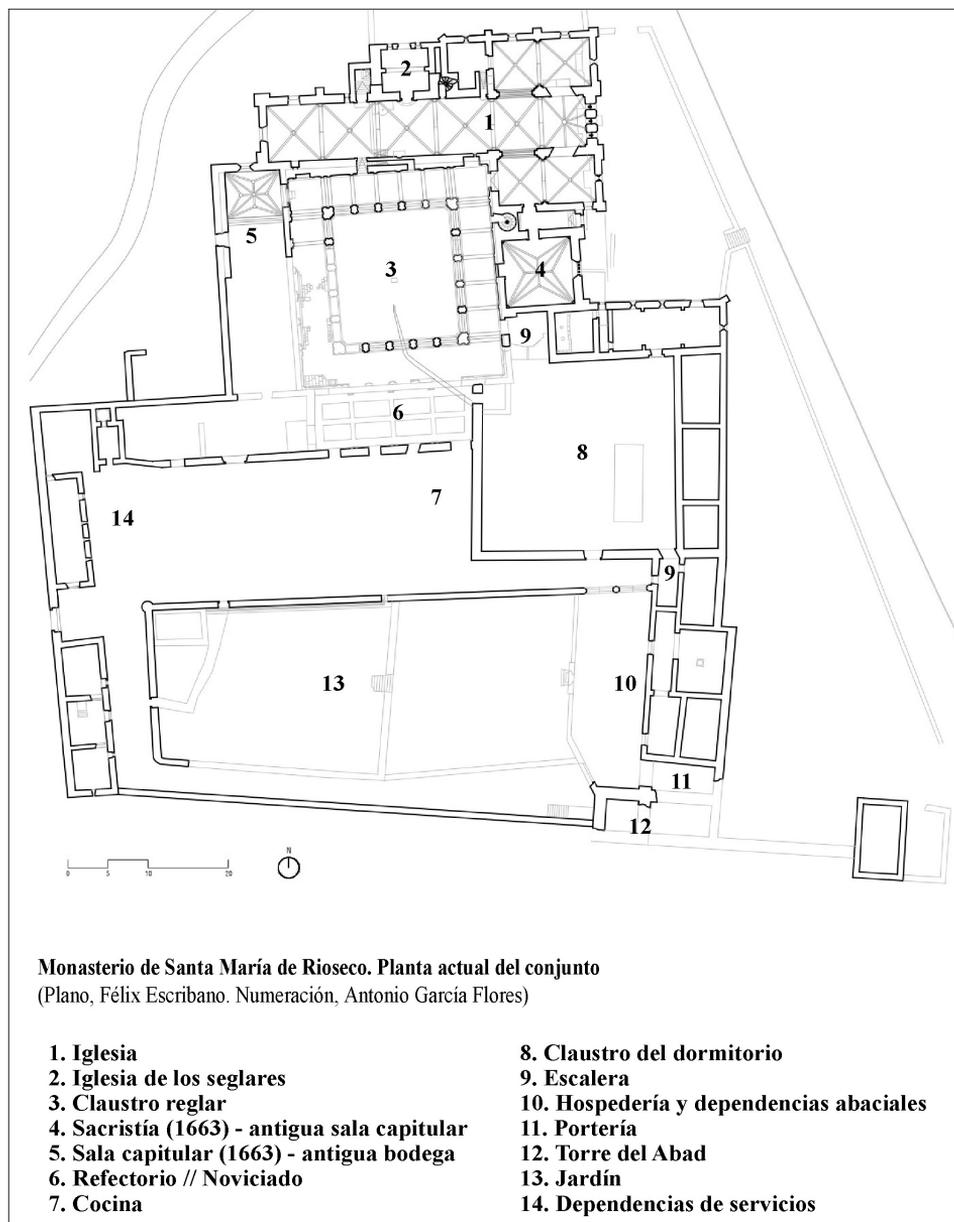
Planta del conjunto monástico de Rioseco.
